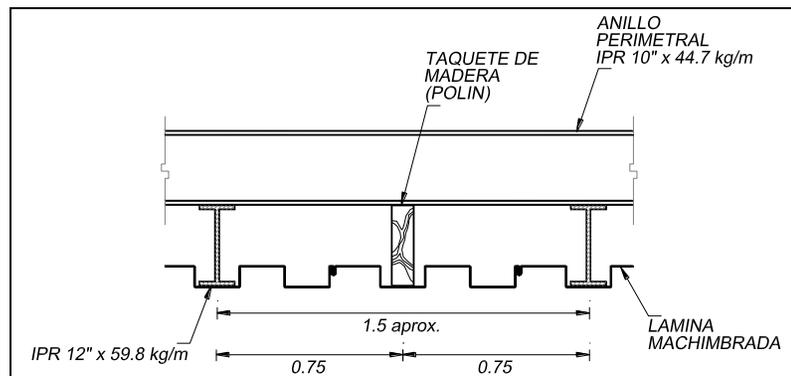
Planta del armado del tablestacado de acero machimbrado. Acotaciones en m. Fuente: Especificaciones RIOBOO S.A.
